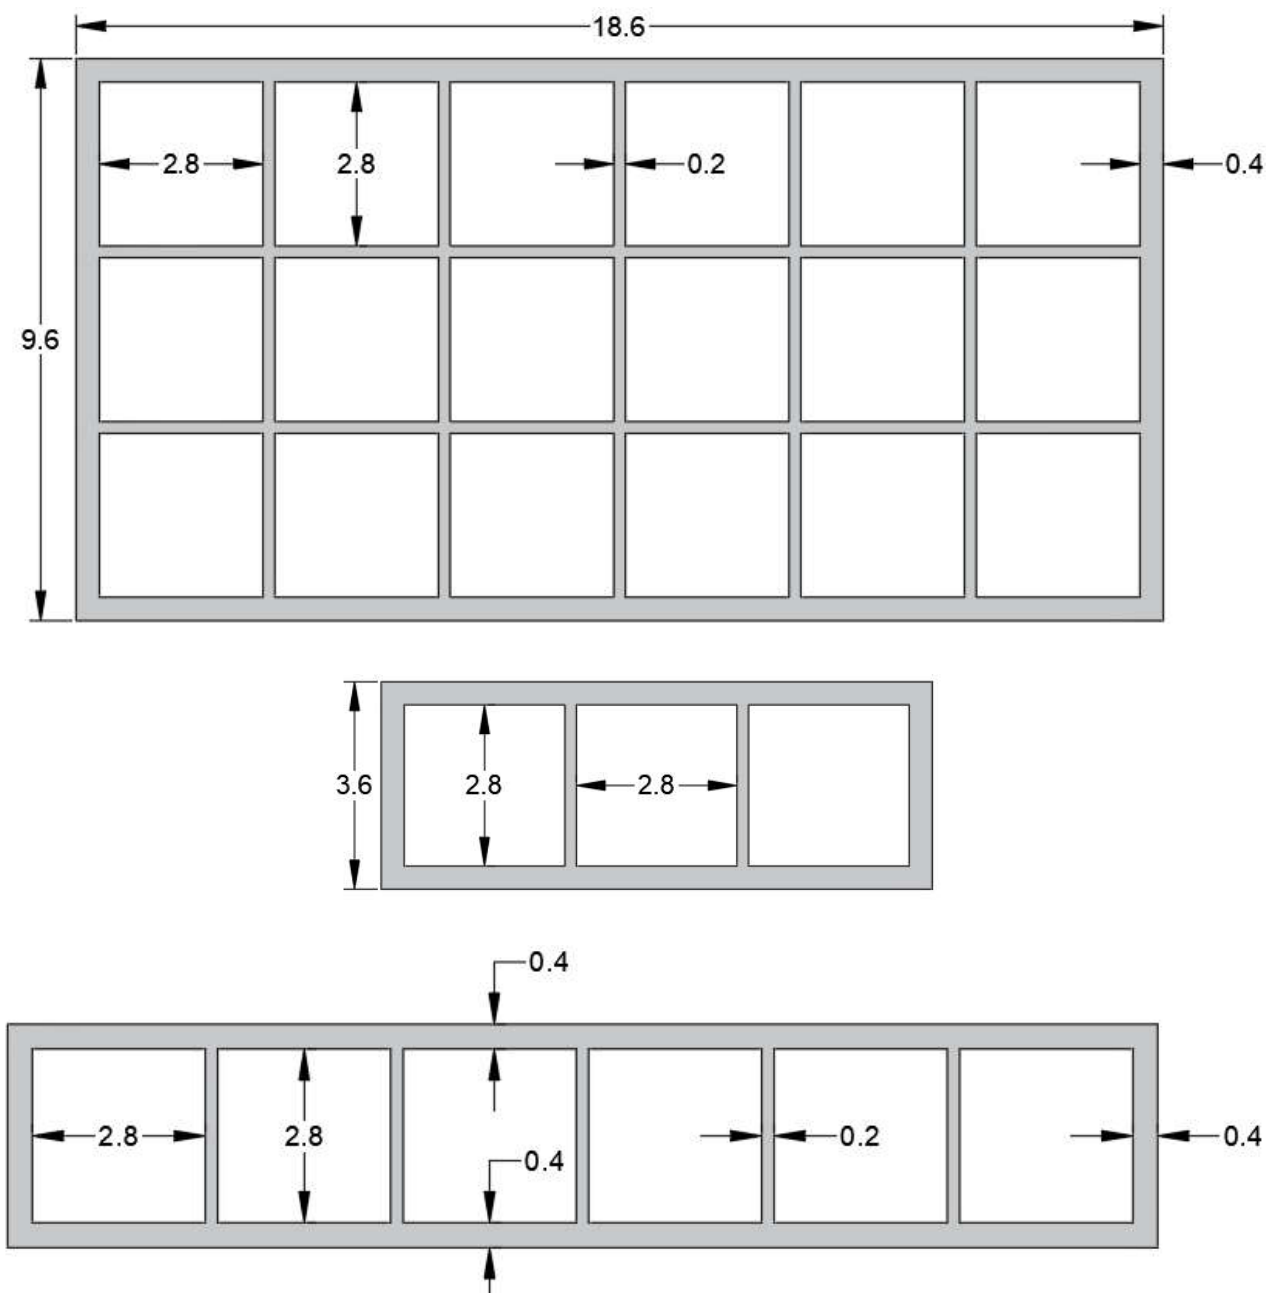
Pianta, sezione trasversale e longitudinale del cassone in calcestruzzo armato
